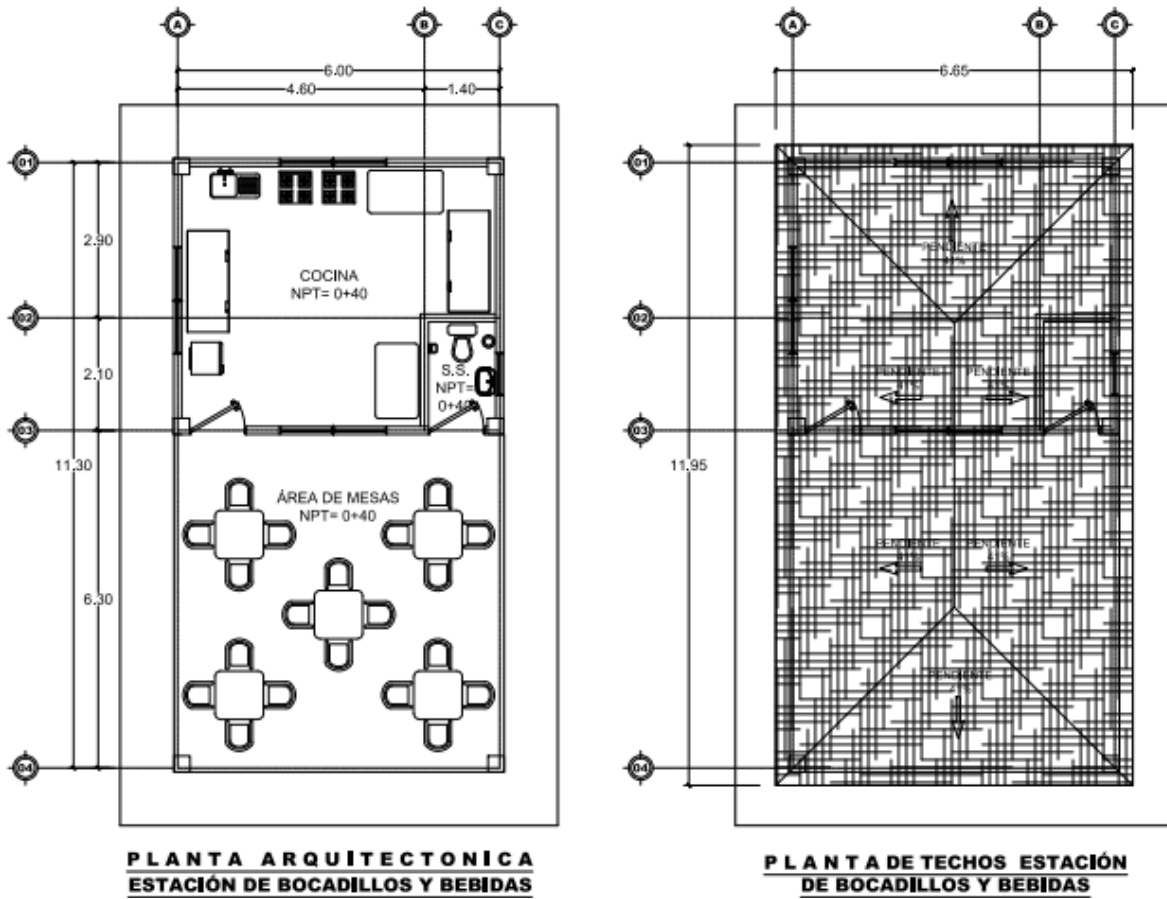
Planta Arquitectonica y techo Estacion de bocadillos y bebidas
